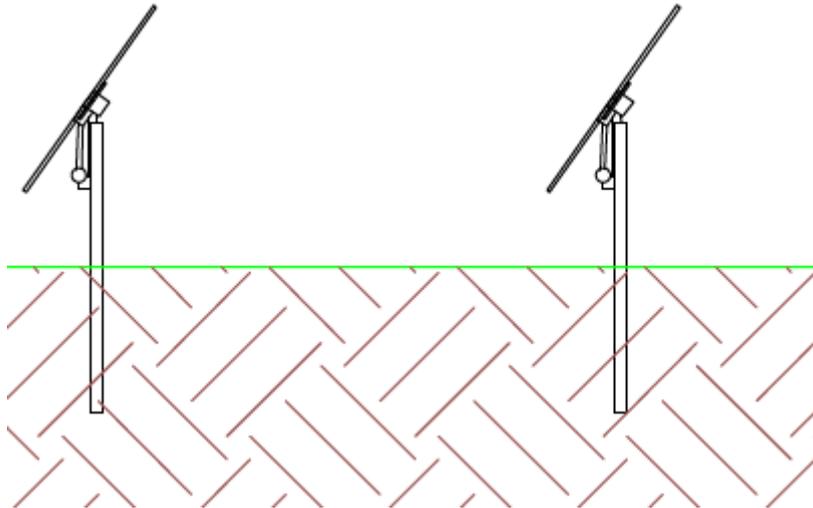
Profilo delle strutture con pali infissi al suolo
